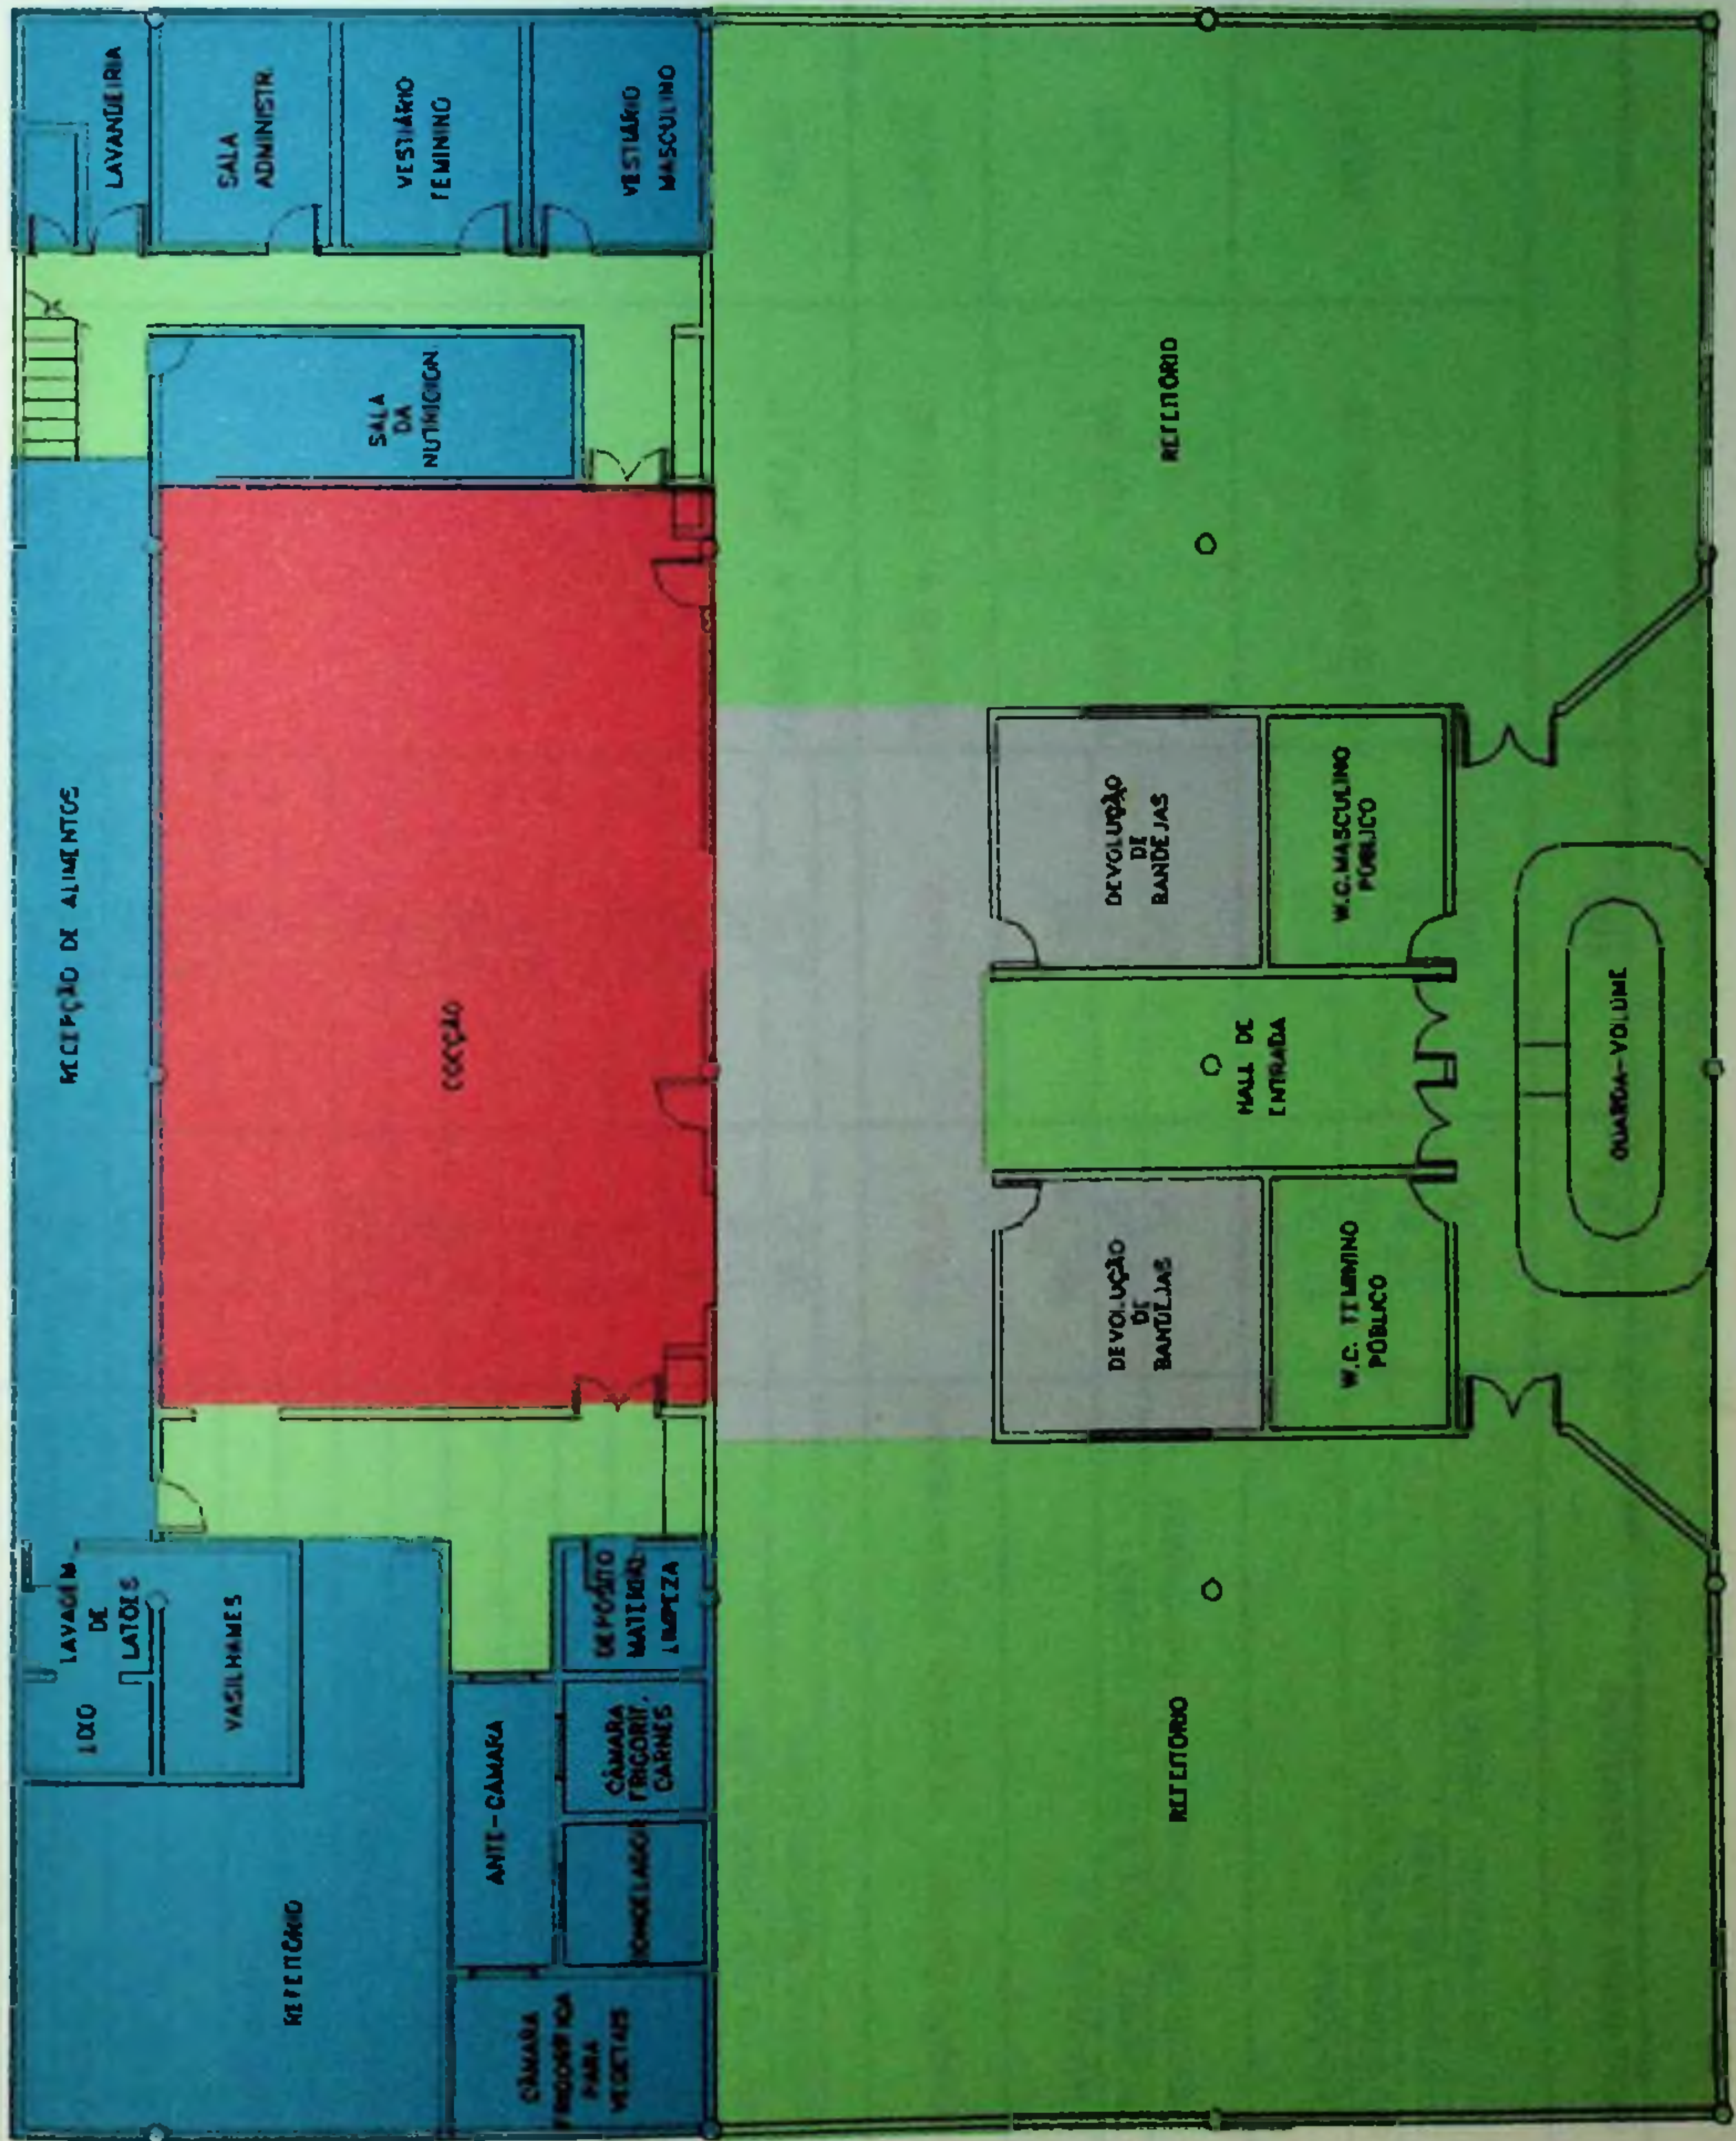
Croqui - Restaurante da Universidade de Londrina
